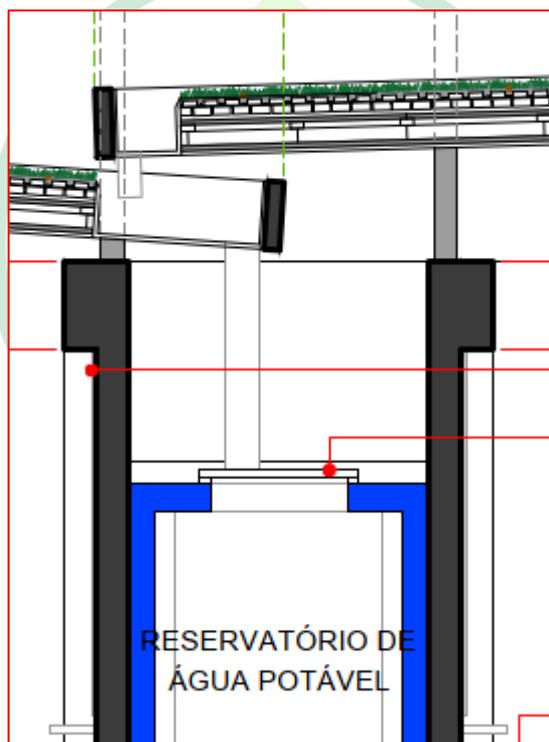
Detalhe de coleta de águas pluviais para cisterna de água – Fonte: CEASA/PR e ARCHSALLES
